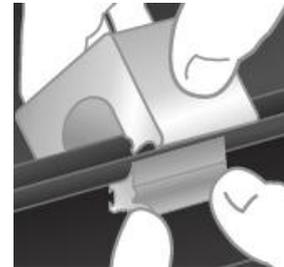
Grundplatte für Stehfalzdach mit 300 mm, 400 mm und 500 mm Bohrungsabständen
